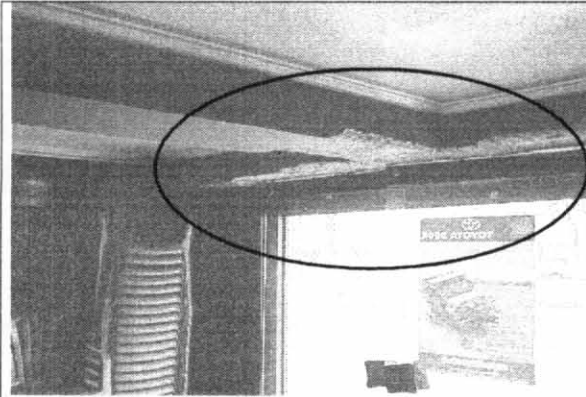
Viga deflectada, se retiró el recubrimiento de esta, para permitir acceso al local.
